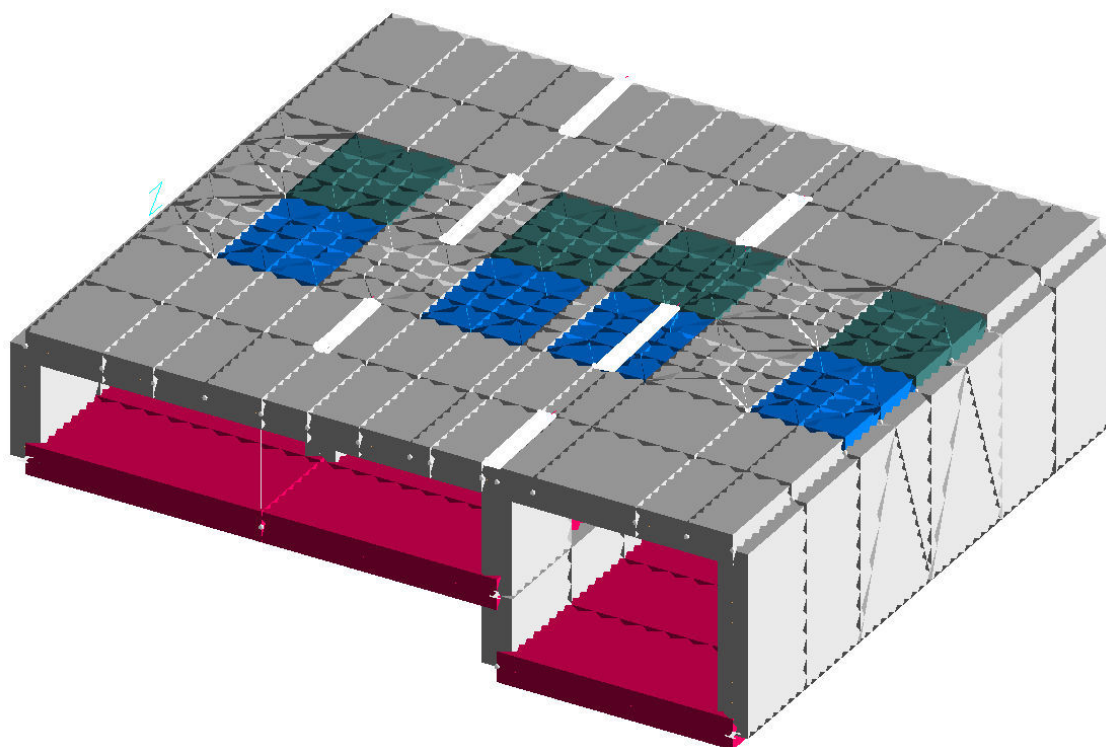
sezione della vasca di laminazione in progetto riportante in blu e verde le aree soggette ai carichi concentrati ed in bianco la posizione dei setti verticali
